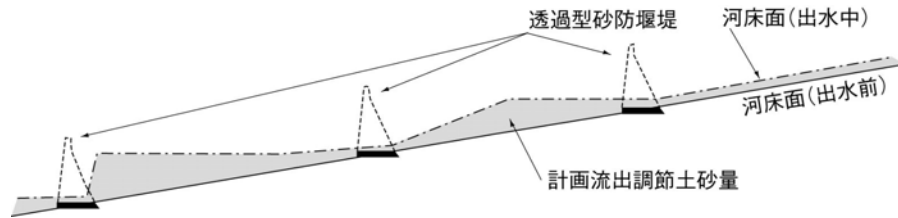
コンクリートスリット砂防堰堤群の流出調節土砂量
